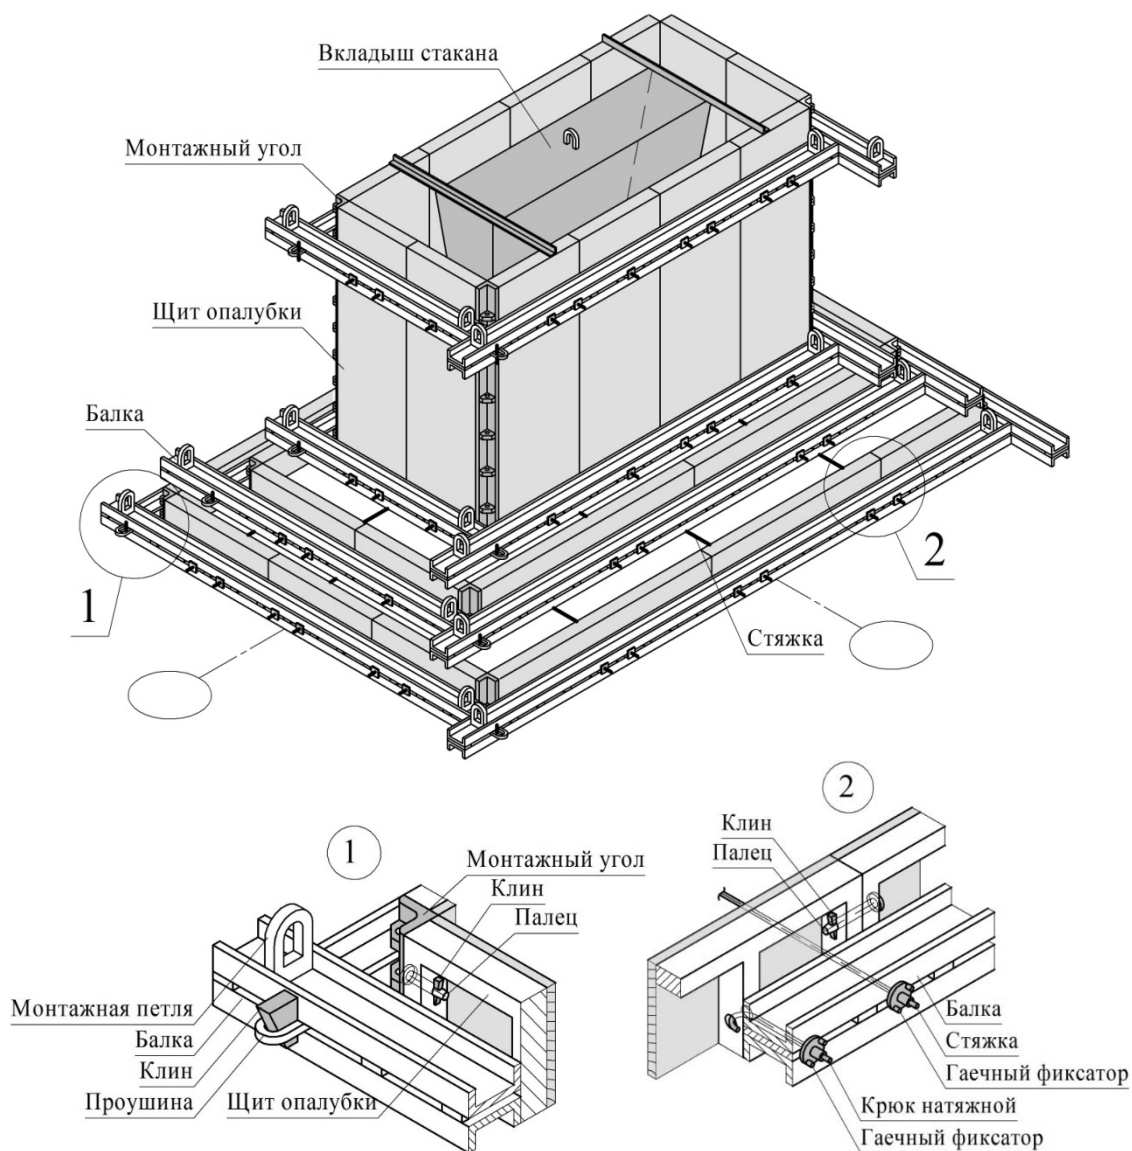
Схема мелкощитовой опалубки монолитного фундамента
